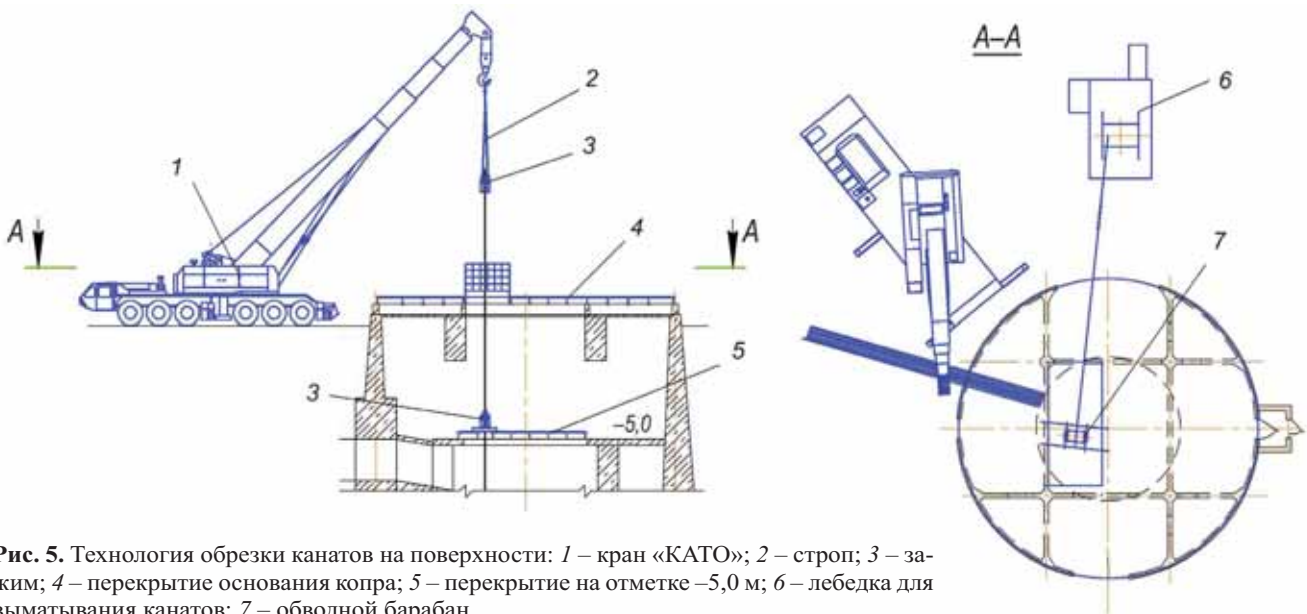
Технология обрезки канатов на поверхности: 1 – кран «КАТО»; 2 – строп; 3 – зажим; 4 – перекрытие основания копра; 5 – перекрытие на отметке –5,0 м; 6 – лебедка для выматывания канатов; 7 – обводной барабан.
